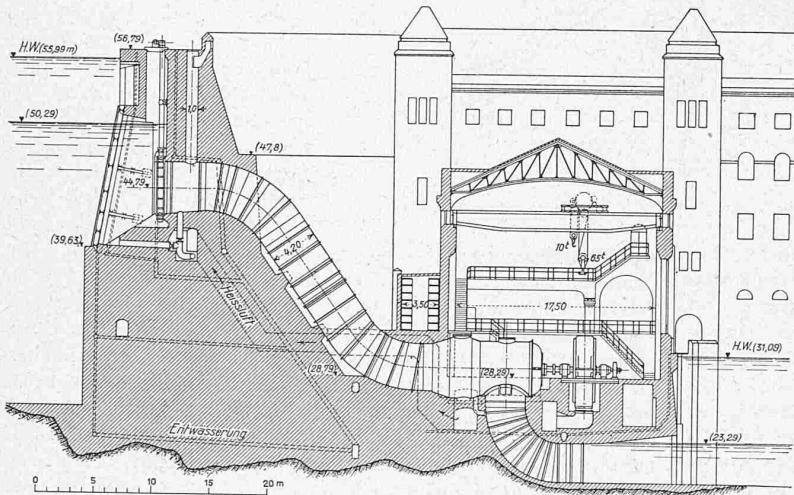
Querschnitt durch Stauwehr und Maschinenhaus. — Masstab 1 : 600.
